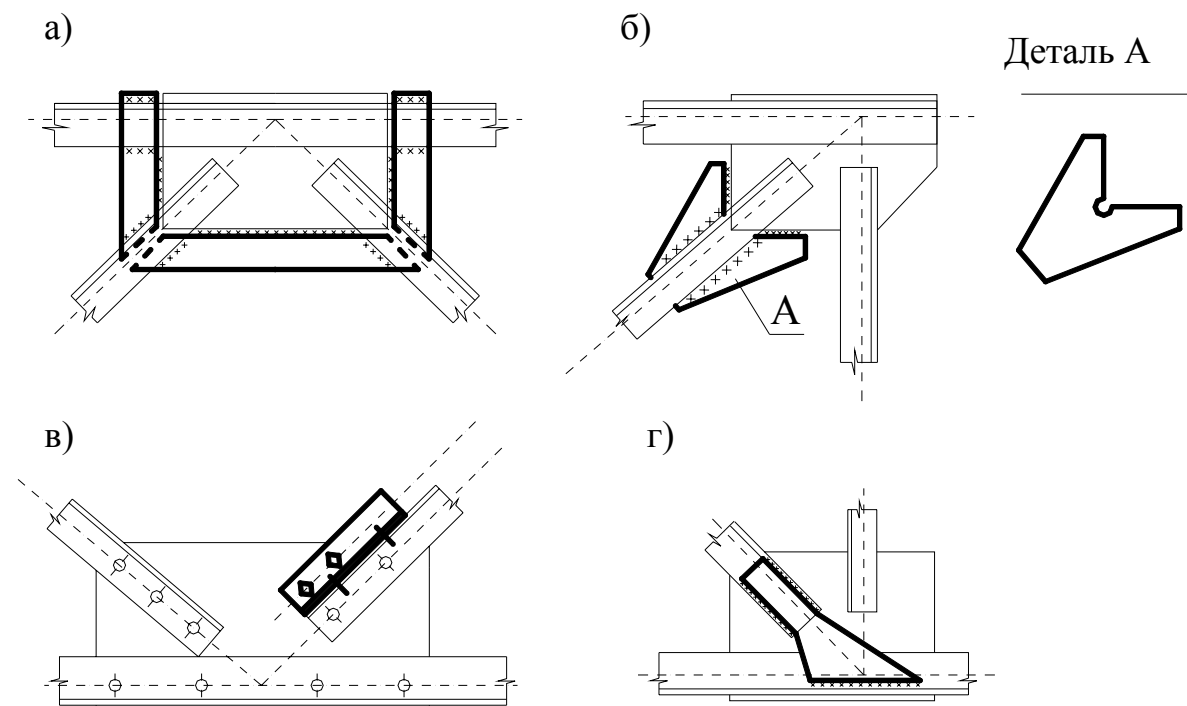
Усиление элементов стропильных ферм: а – м – схемы усиления
